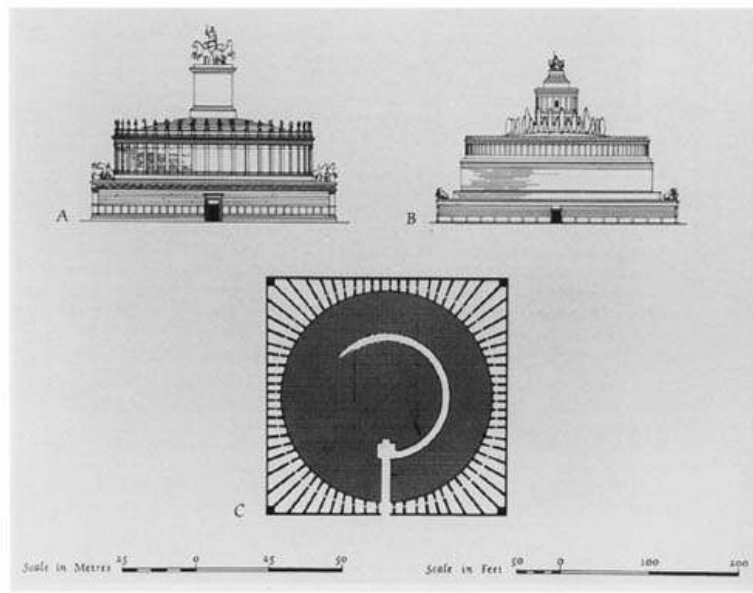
Reconstrucción y planta del mausoleo de Adriano.
